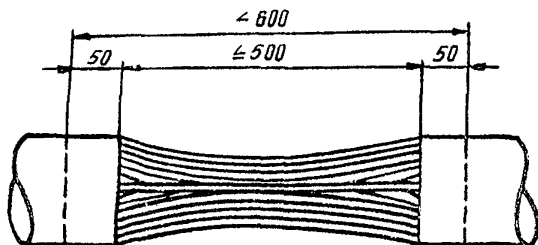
Подготовка кабеля к ремонту шланговой оболочки
